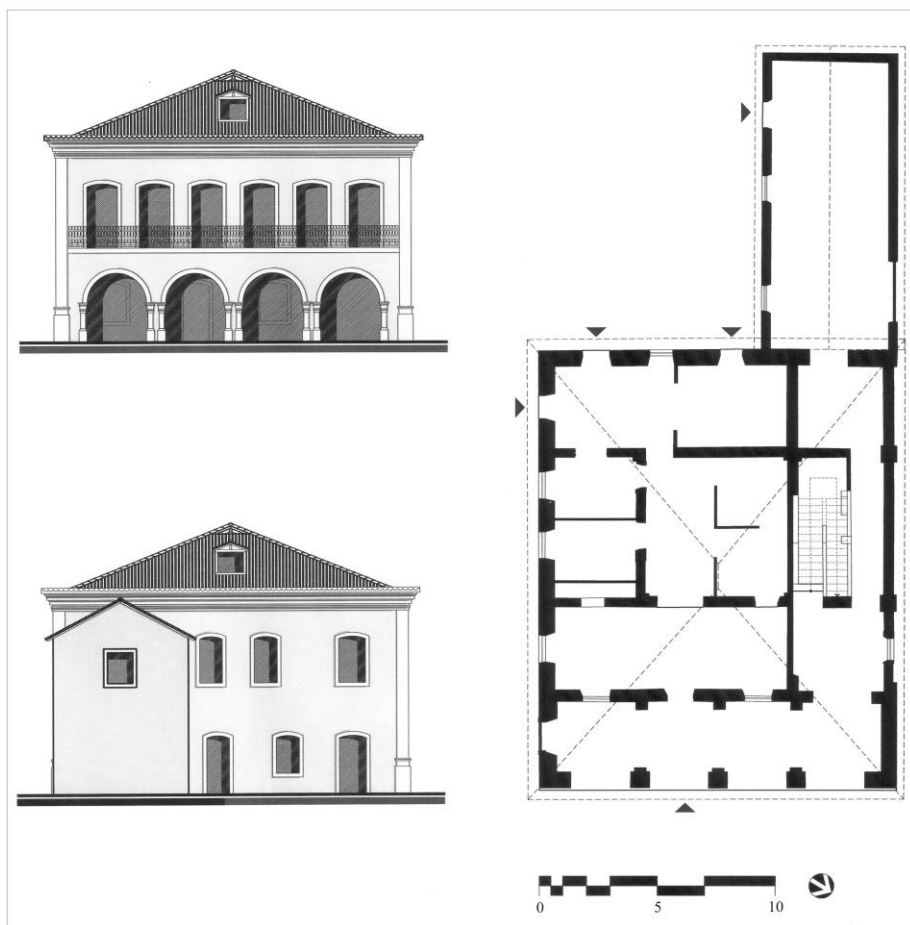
Fachadas frontal e posterior e planta baixa do pavimento térreo, elaboradas a partir do levantamento espacial da casa-grande do Engenho Monjope.
